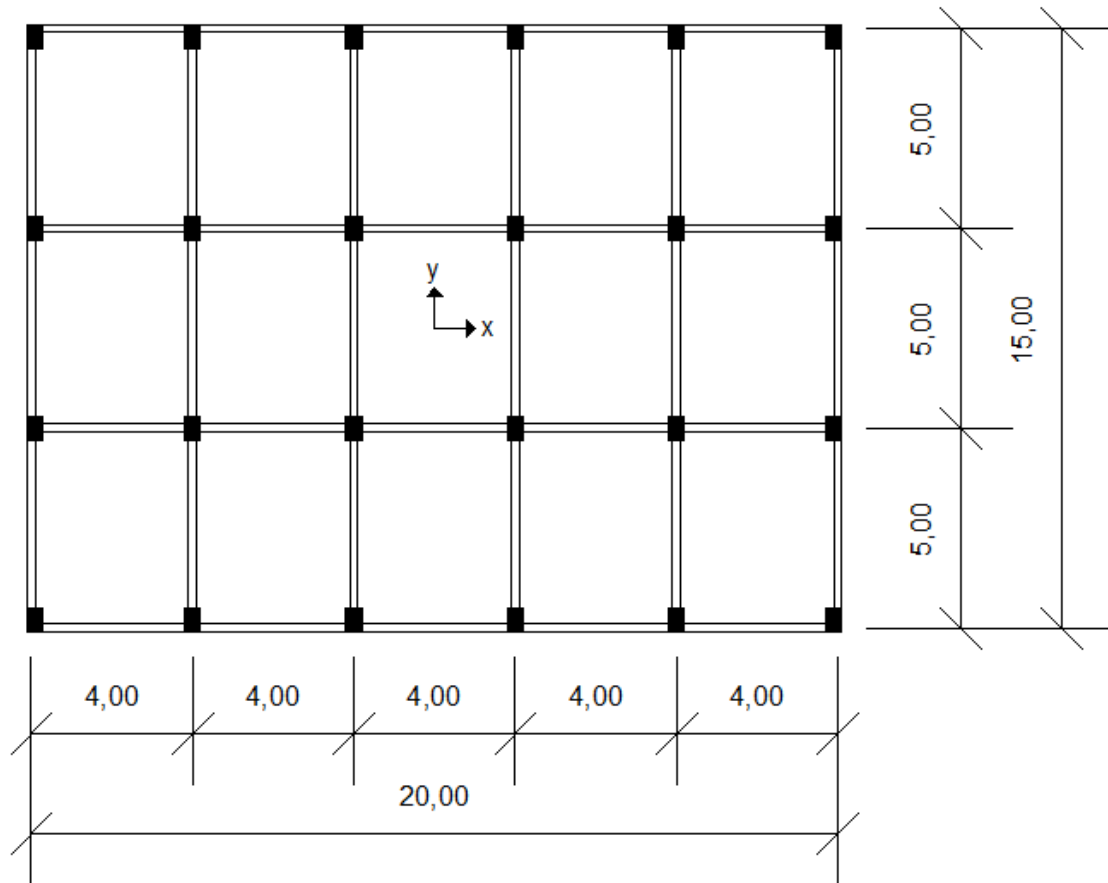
Disposição em Planta dos Elementos Estruturais do Edifício PT8
